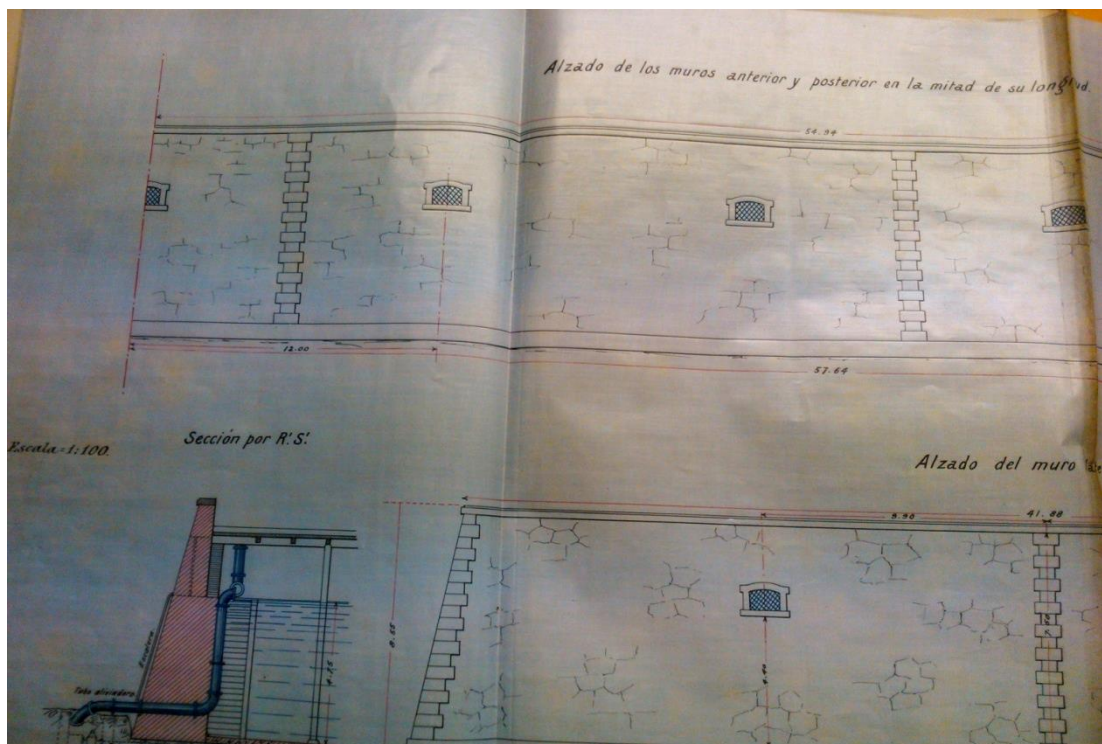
Proyecto de tercer depósito de Gijón. Muro exterior. Archivo Municipal de Gijón. Expediente No.132
